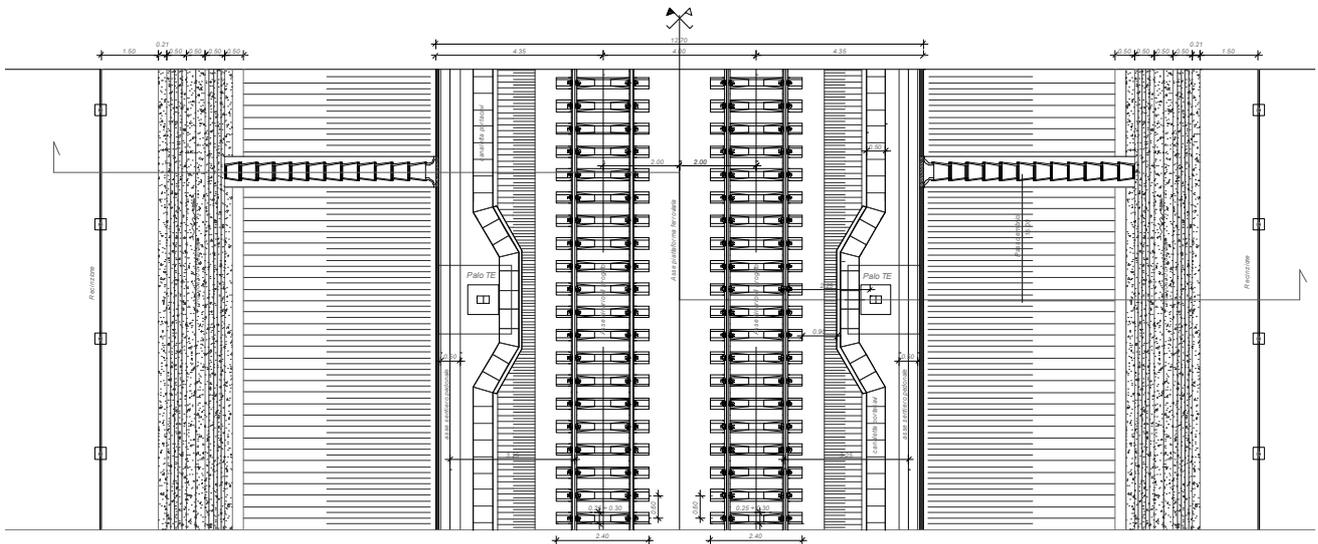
Stralcio planimetrico per sezione tipo ferroviaria in rilevato a doppio binario (piattaforma in retto) con $H_{ril} \leq 6,00$ m
